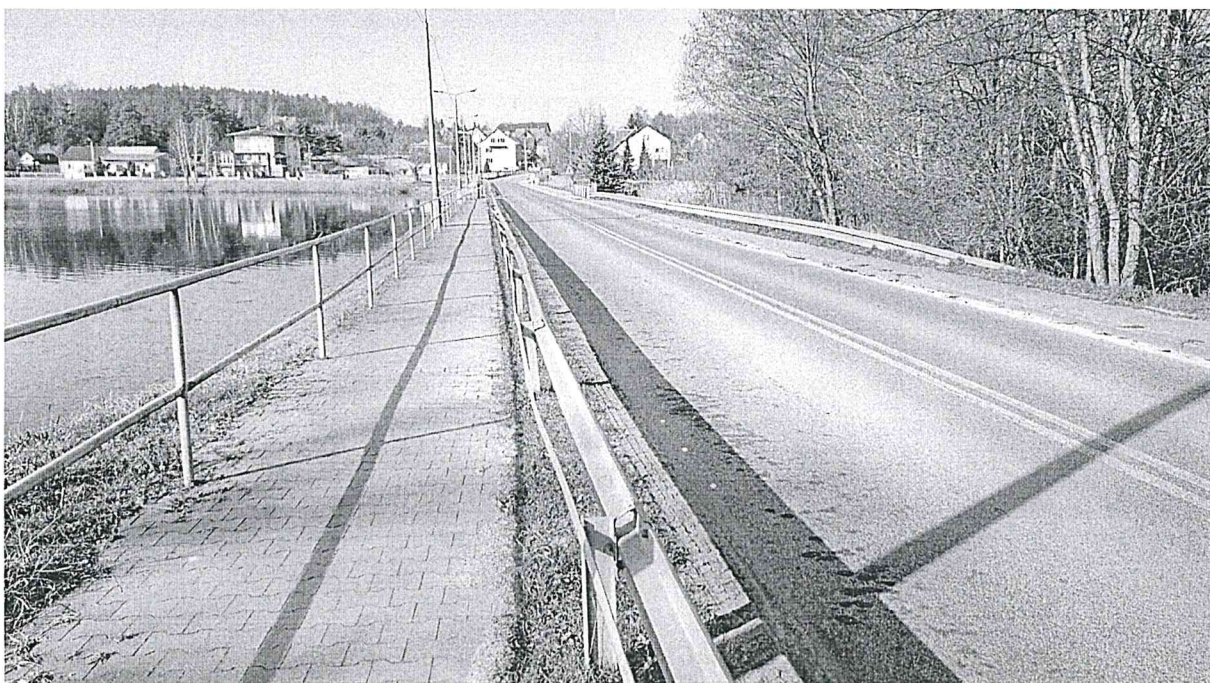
Rejon prawego przyczółka jazu od strony WG. Widoczne zapadnięcie betonowego ubezpieczenia skarpy odwodnej zapory czołowej.
